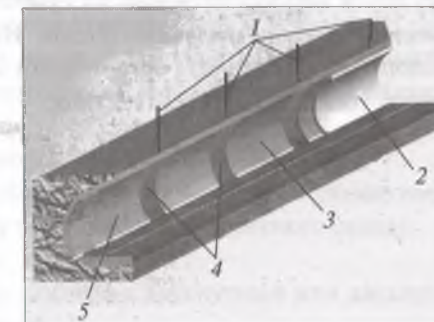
Устройство в тоннеле гидроизоляционной мембраны, создаваемой методом набрызга, с дренажной системой:
